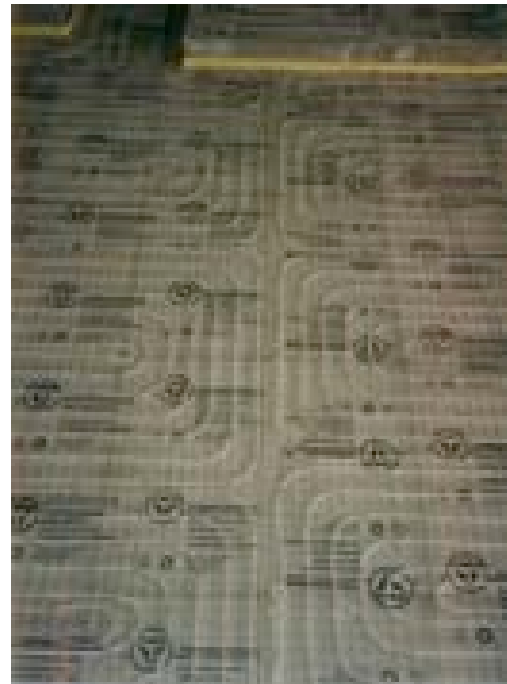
SX, la posa del riscaldamento radiante – (AABS-1998_01_27 - Foto Santa Rosa_02)
